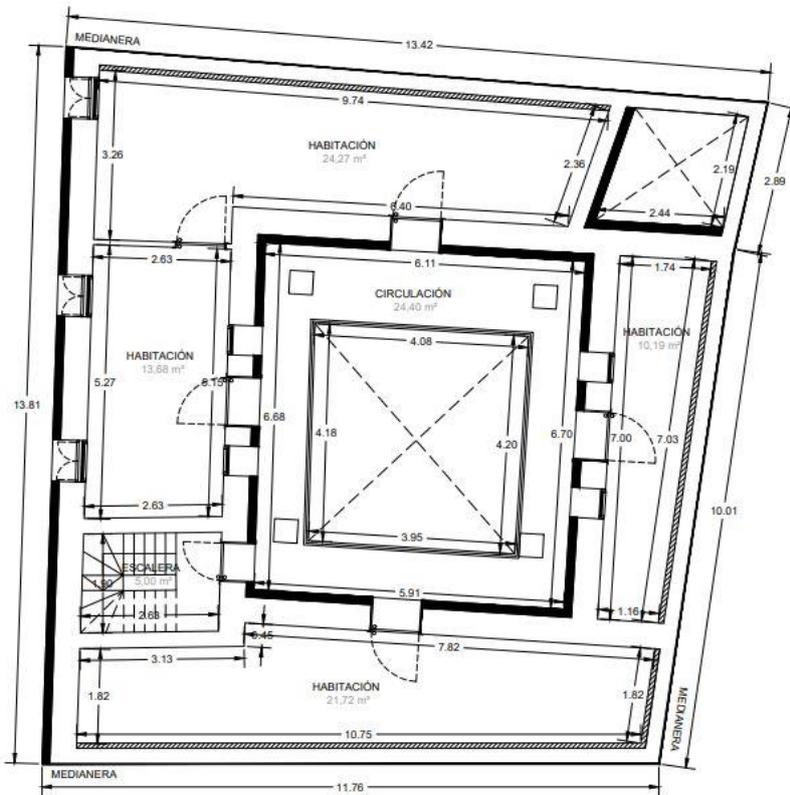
Plano planta baja del edificio (Elaboración propia)
